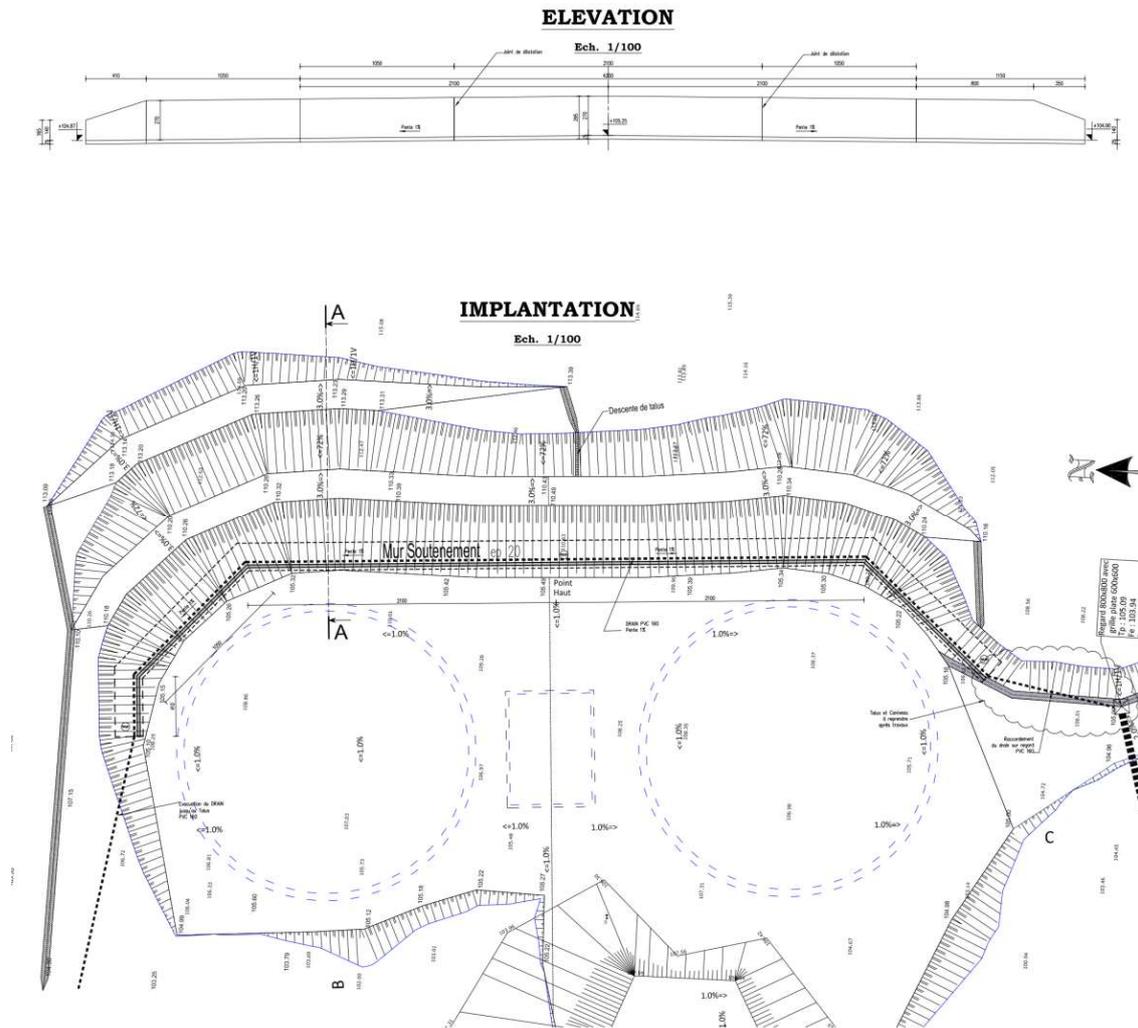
vue en plan et élévation de l'ouvrage en béton armé
